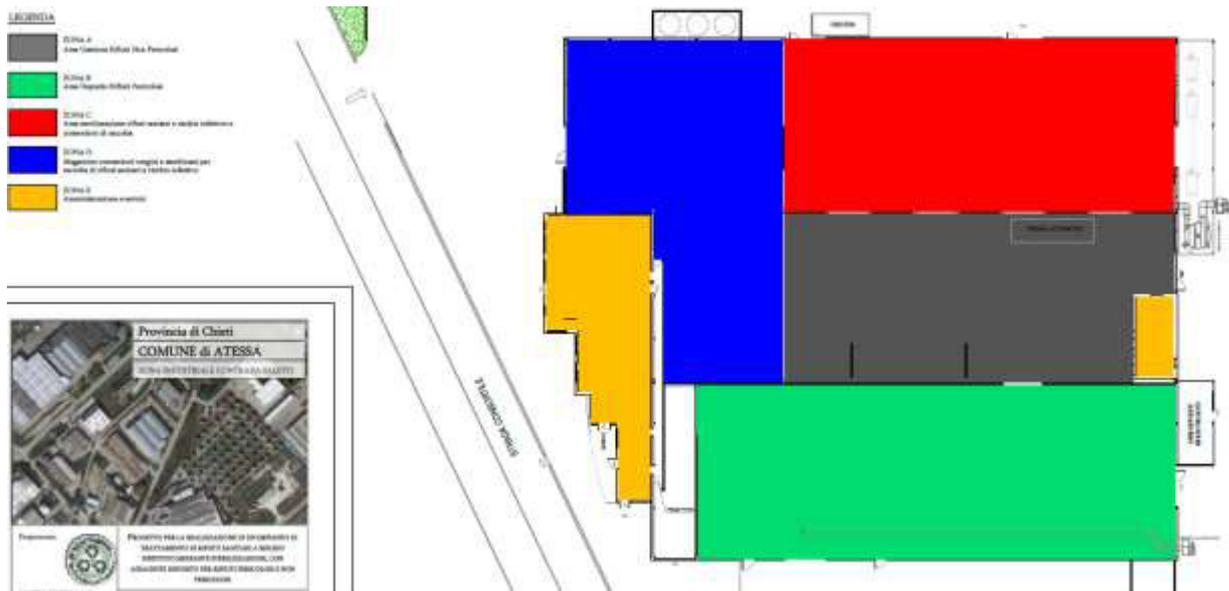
Planimetria layout impiantistico (Tav PRD3 allegata allo SIA)
